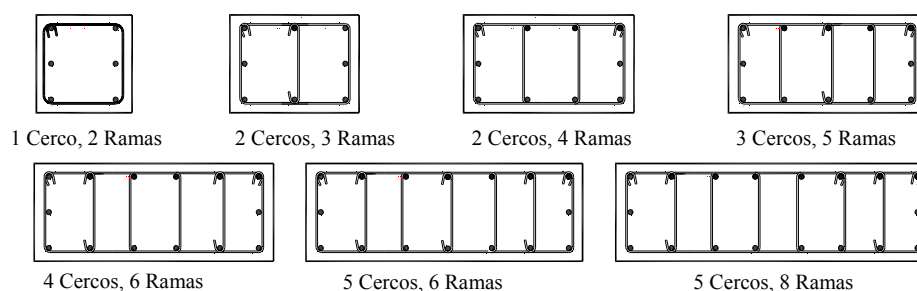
Modelo 2. Zapata excéntrica con viga centradora. Armado a cortante
